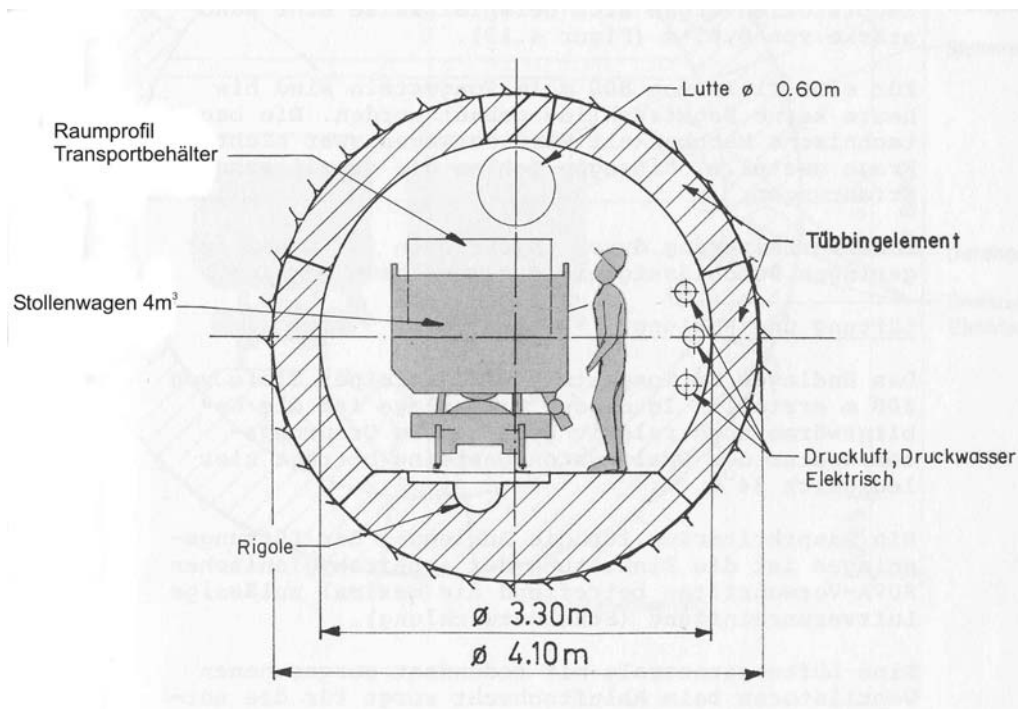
Querschnitt einer Einlagerungsstrecke
